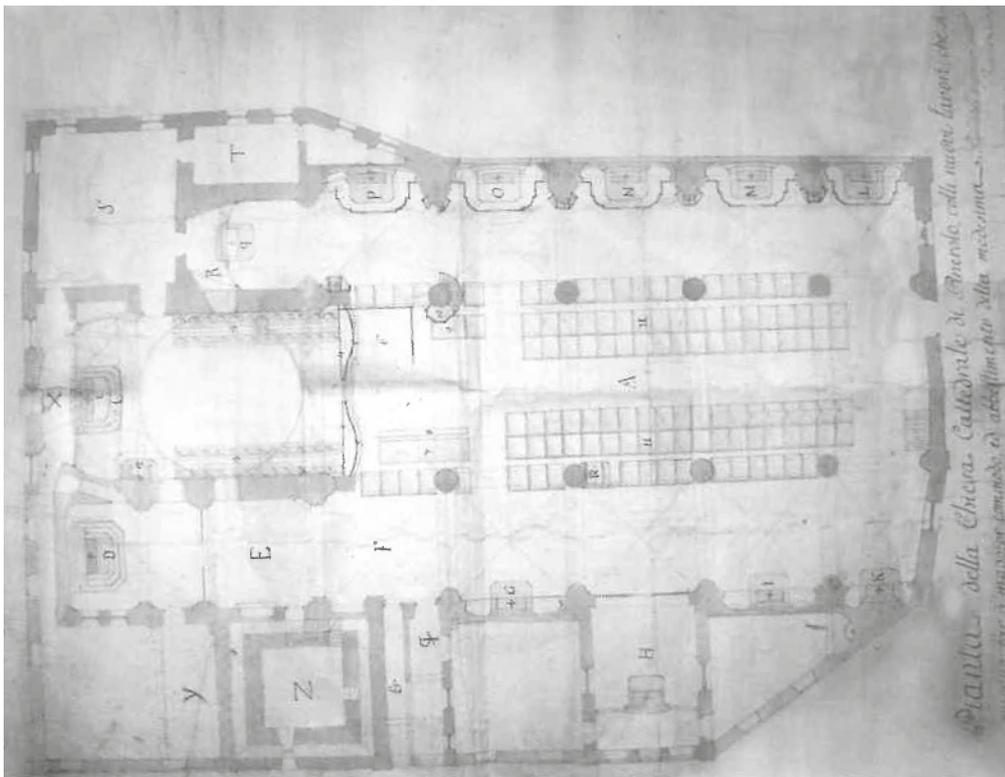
Pianta sistemazione interna di San Donato dell'ingegnere Gerolamo Buniva del 1766
